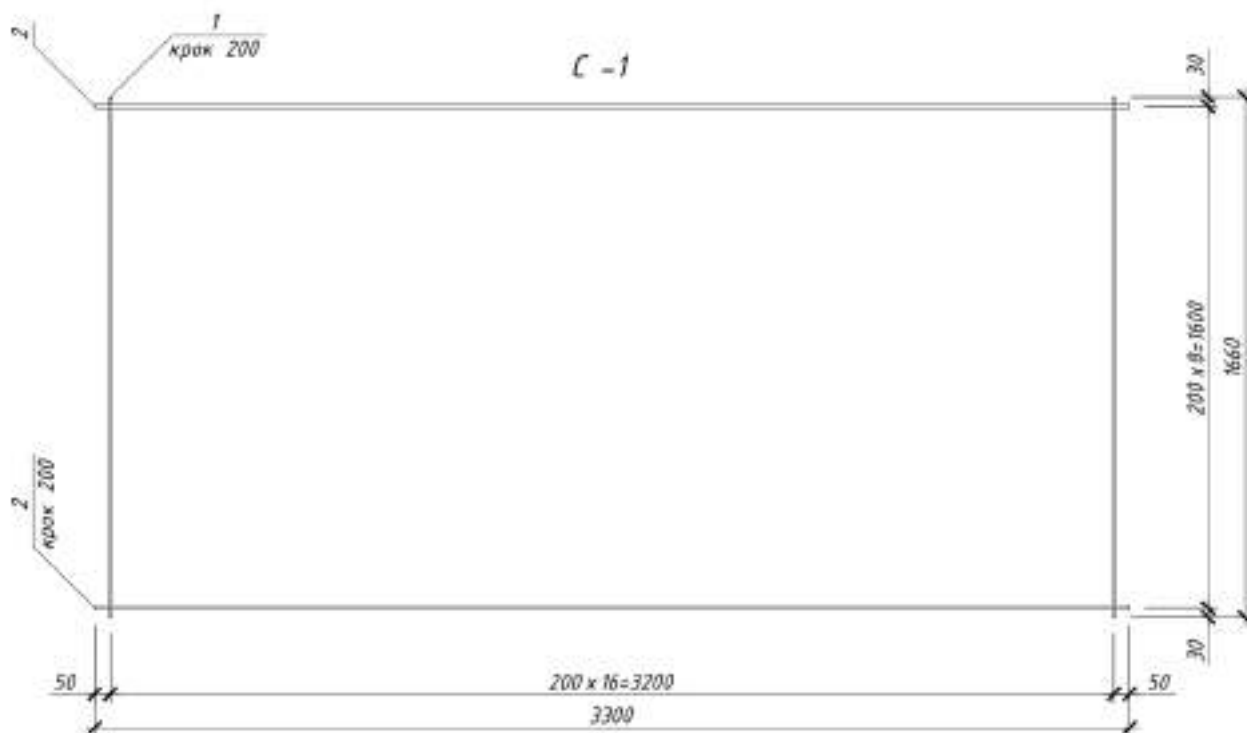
Зварна сітка до розрахунку армування плитної частини фундаменту
